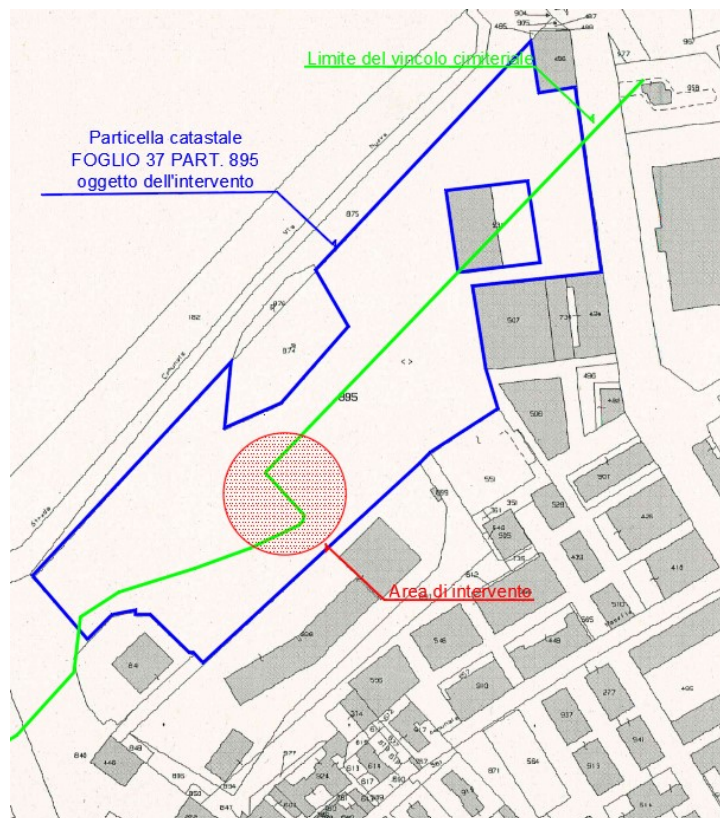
Planimetrica Catastale con indicazione area d'intervento
